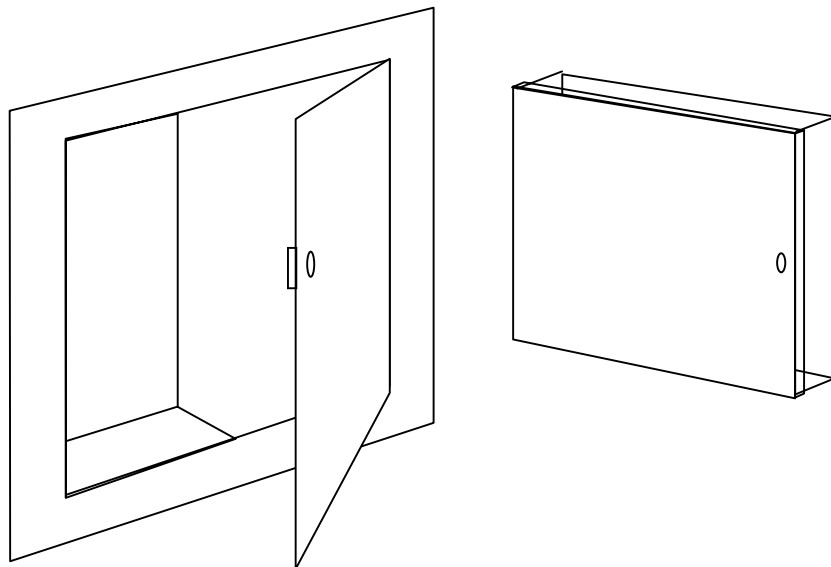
Внешний вид и варианты исполнения Этажного прибора
